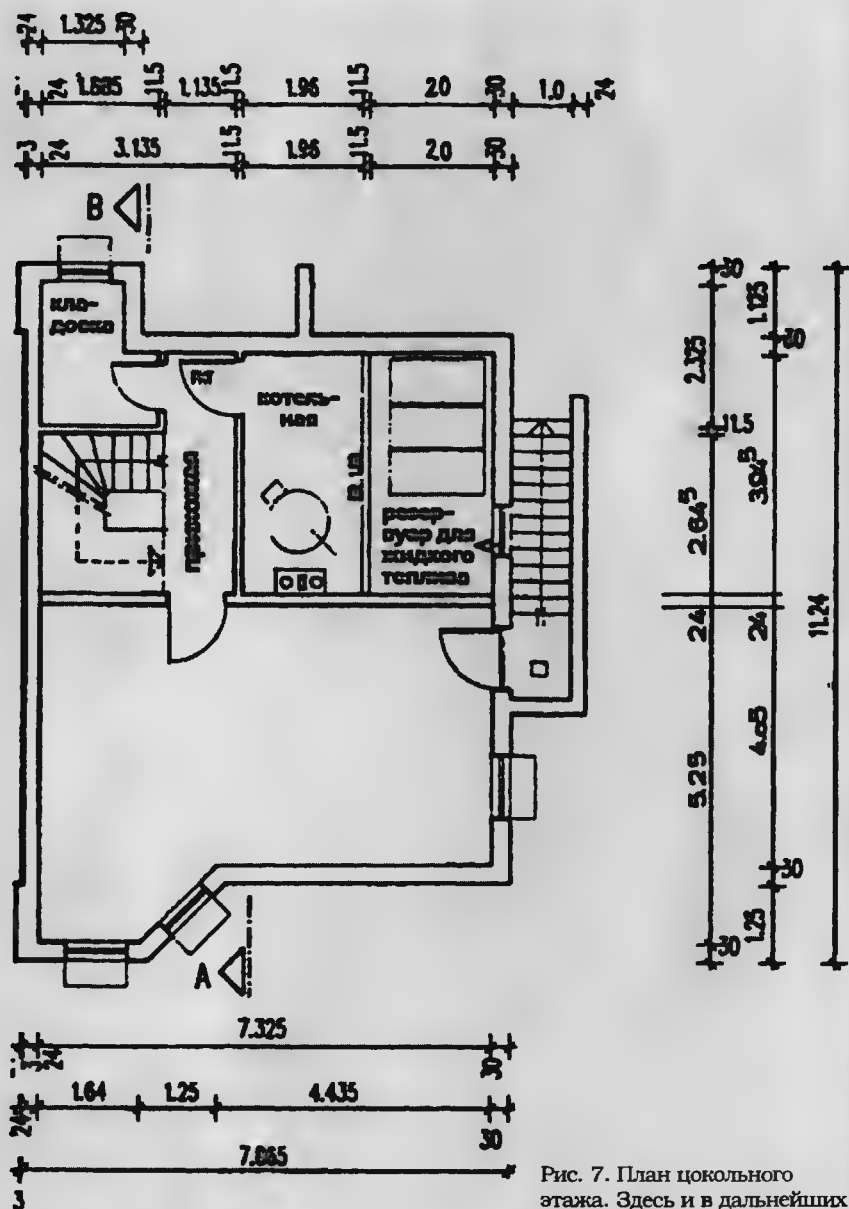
План цокольного этажа. Здесь и в дальнейших планах показана половина двухквартирного дома
